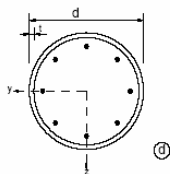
Sezione tipo di colonna composta circolare riempita di calcestruzzo in cui è possibile considerare il confinamento del calcestruzzo
